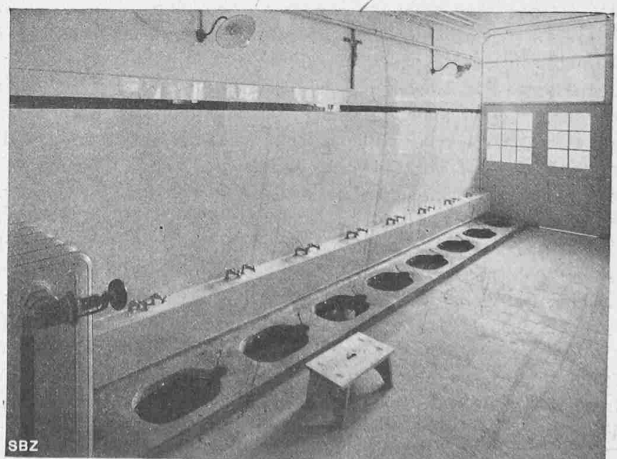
Fussbad-Becken (vergl. Grundriss Seite 285).
